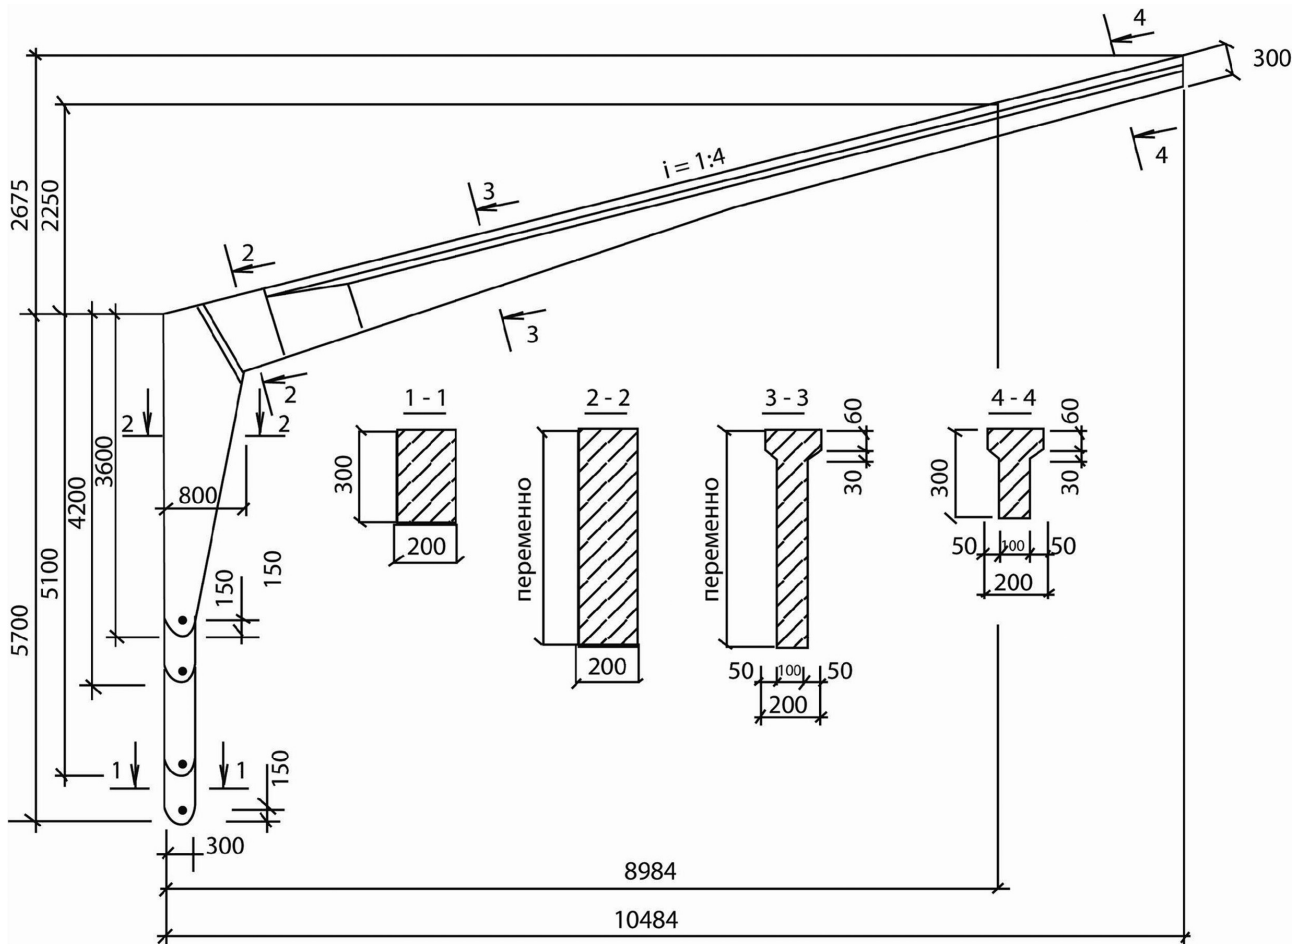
Уніфікована піврама (Укрколгоспроект, КІБІ)
